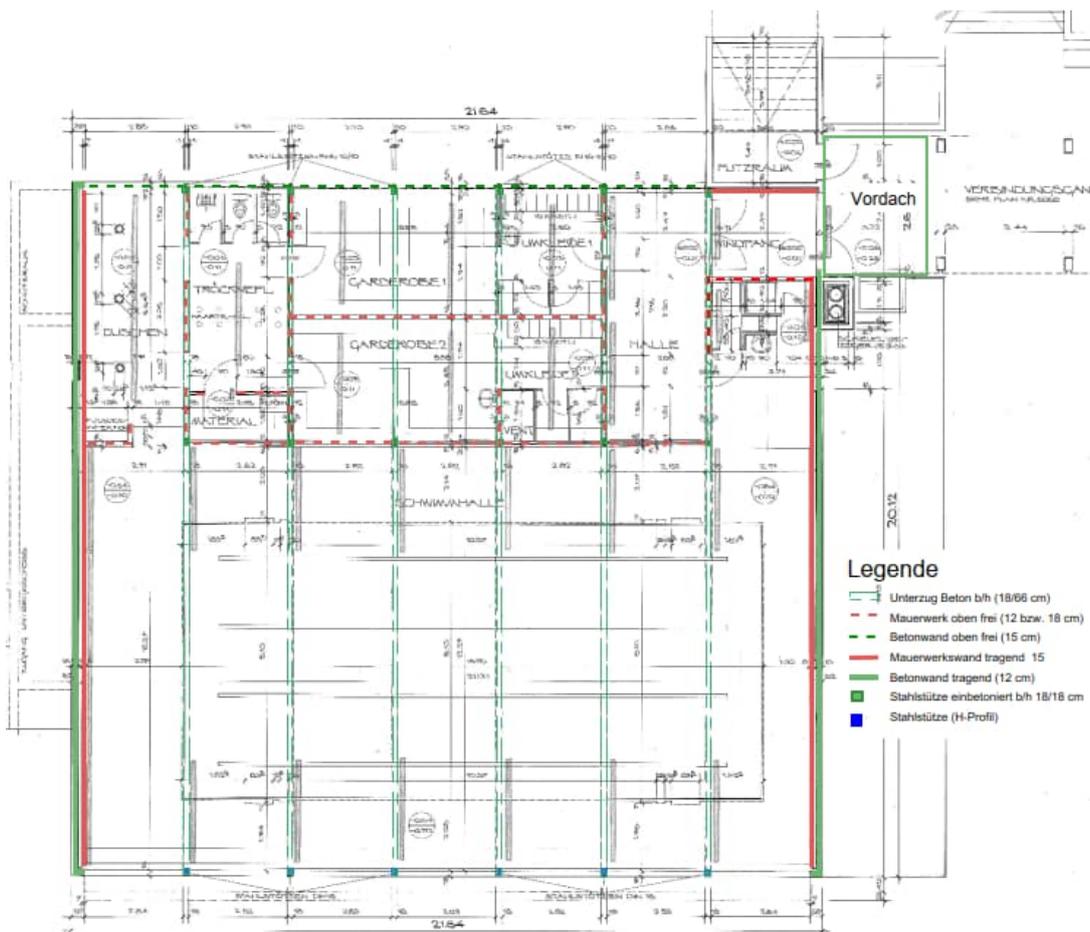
Tragsystem Grundriss Erdgeschoss
